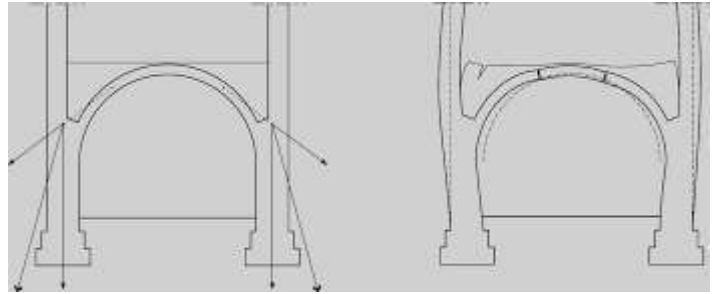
déformation d'un plancher sous la poussée d'un arc.
